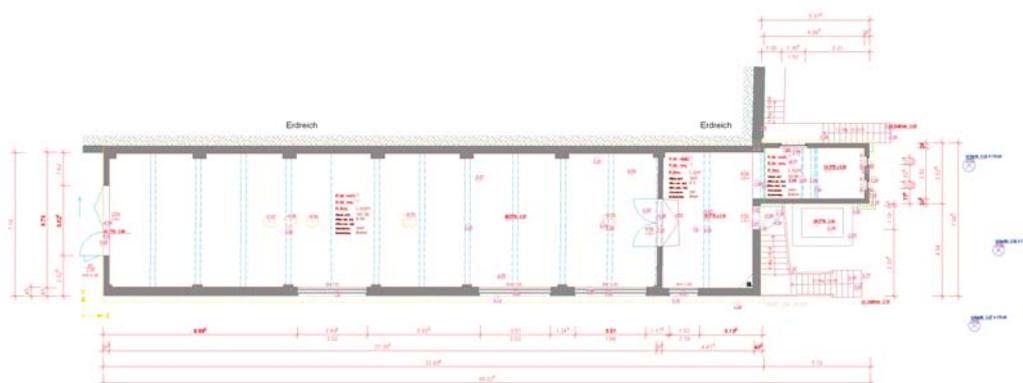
Planlayout Gebäude Nr. 70, Ebene 1 in AutoCAD
